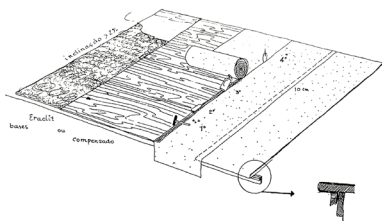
Detalhe da solução de impermeabilização adotada para a cobertura.
